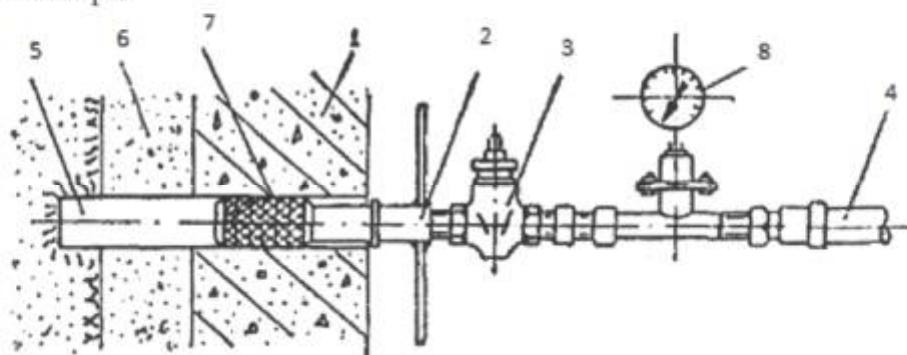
1 - обделка; 2 - нажимная гайка с рукоятками; 3 - кран запорный; 4 - рукав растворовода; 5 - шпур; 6 - затвердевший раствор; 7- уплотнитель резиновый; 8 - манометр с предохранительной камерой.
